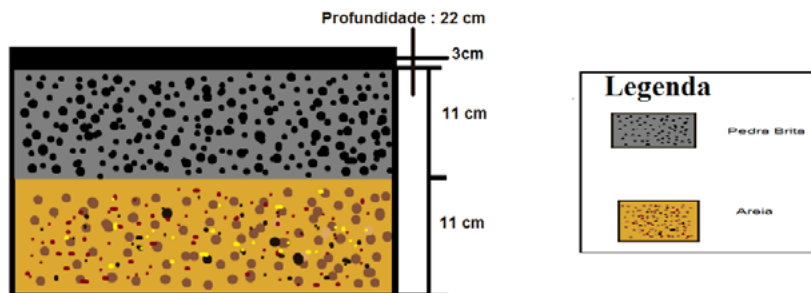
Sistema piloto em corte, com dimensões da pedra brita e areia
